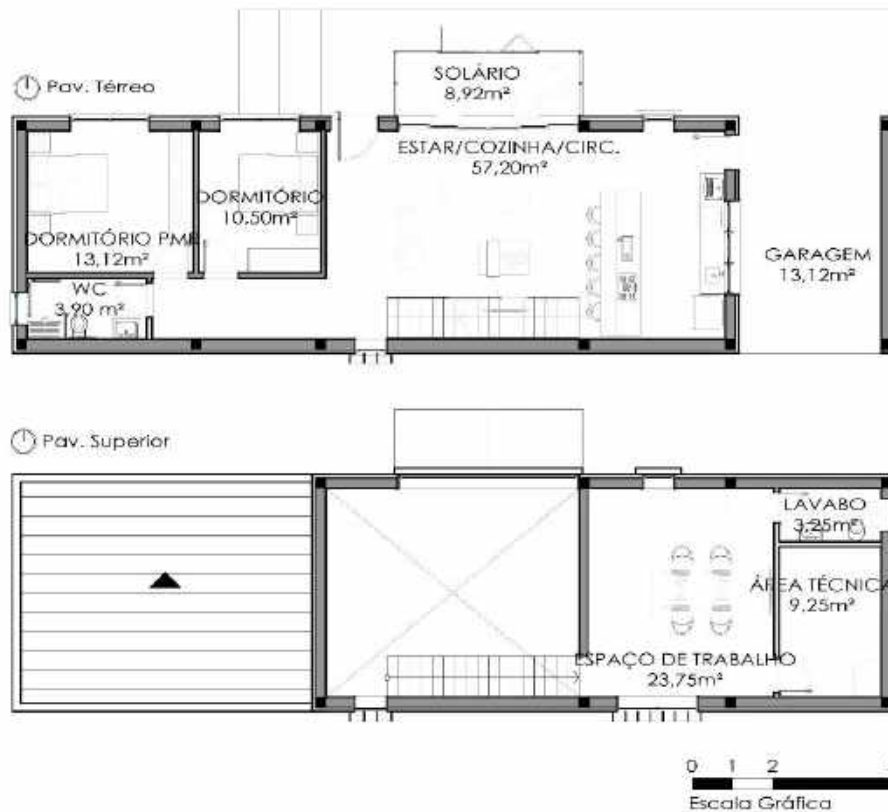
Planta baixa térreo e segundo pavimento, para orientação Norte. Adaptado de Dalbem, 2015.
